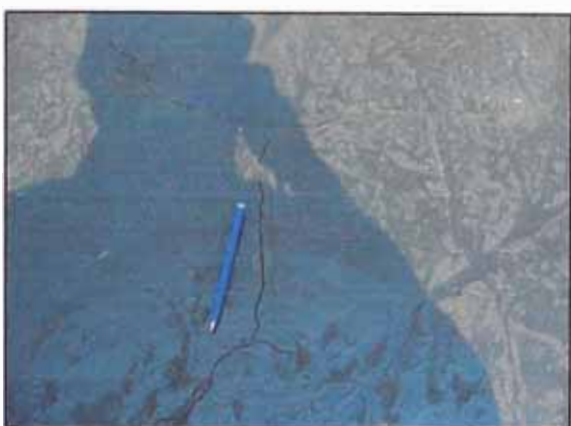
Fisuras a temprana edad en base suelo cemento imprimado.
